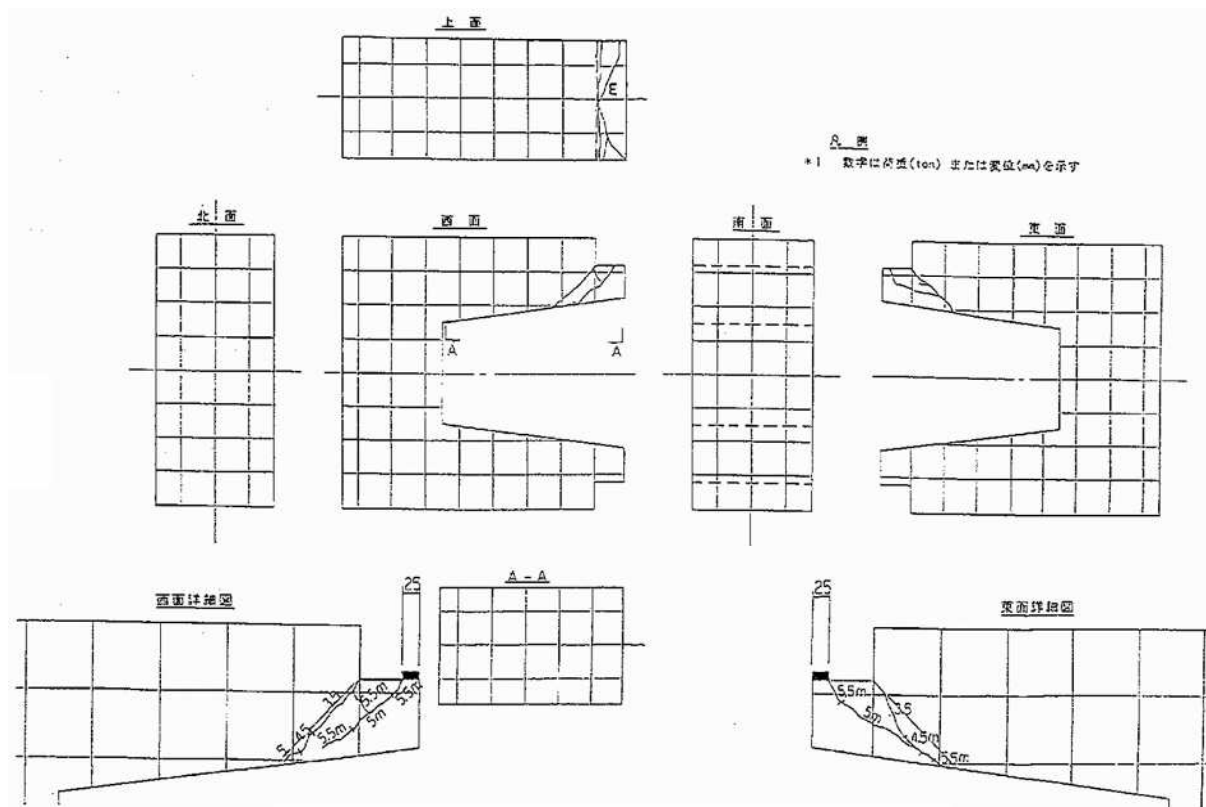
切欠部供試体(その 1)ひび割れ図(掛かり長 25mm) (単位:mm)
